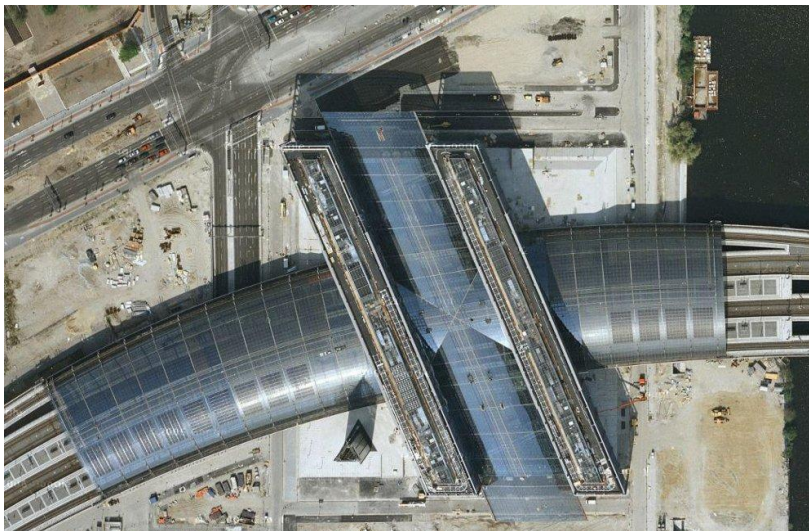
Крыша здания Berliner Hauptbahnhof
